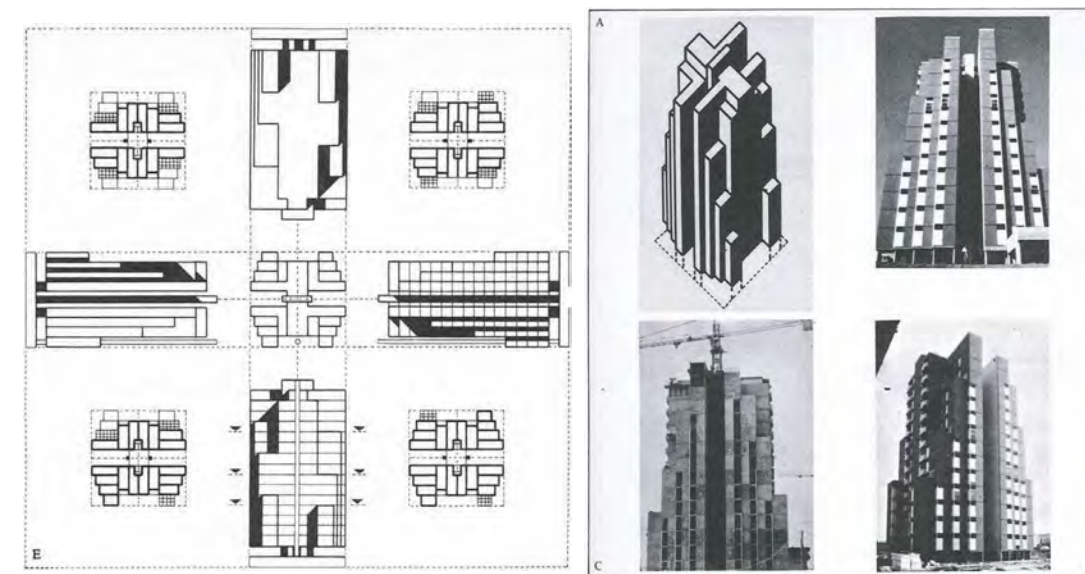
Laurentino, Roma: Tipologie edilizie nel Settore Nord Est - Case a torre (14 piani) - Schemi. Gli edifici costruiti con sistemi a tunnel sono stati progettati da Pietro Barucci. Fondo Pietro Barucci
